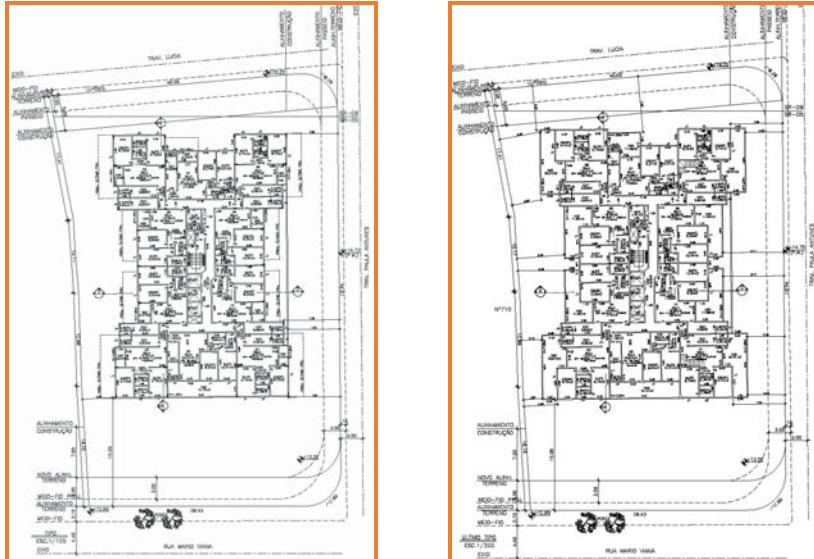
Pavimento Tipo e Último tipo – Fonte: Projeto Legal
